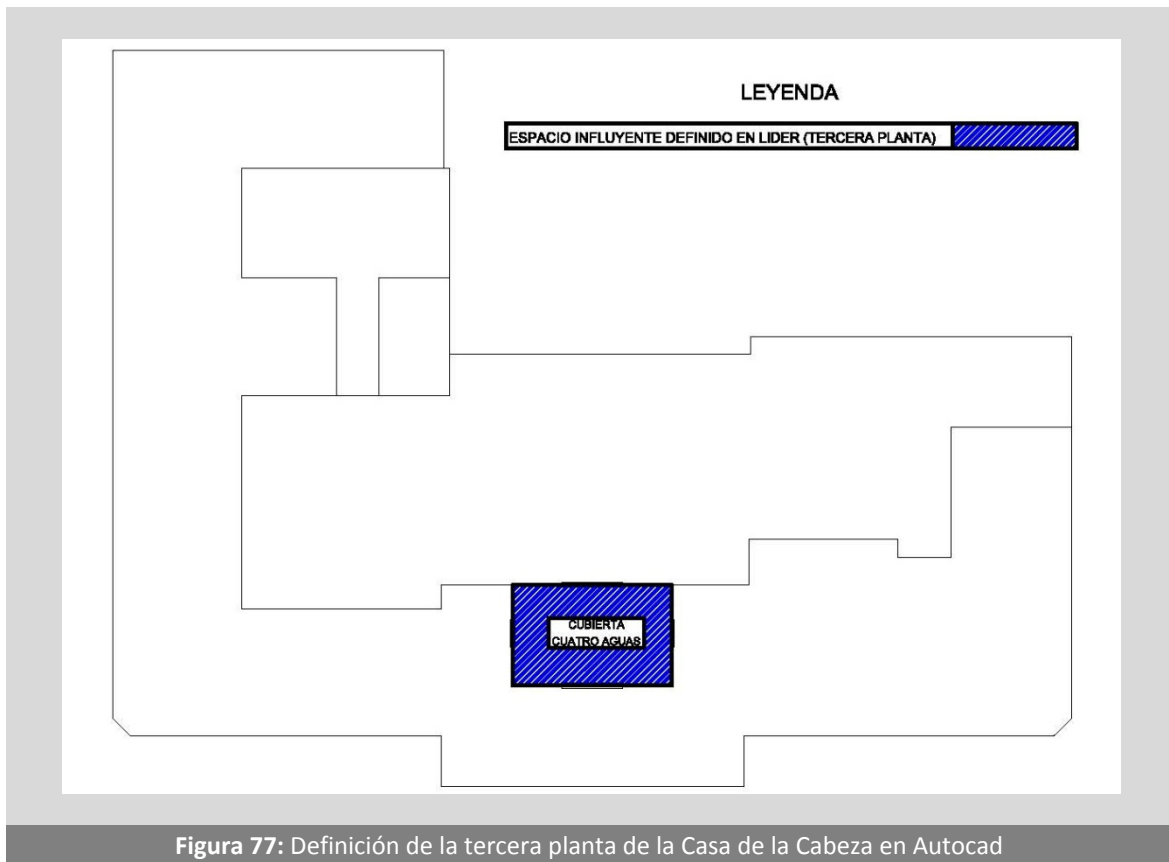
Definición de la tercera planta de la Casa de la Cabeza en Autocad
